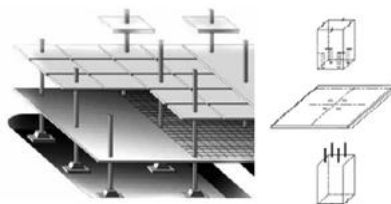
Схема каркаса и схема соединения плит перекрытий с колоннами в системе УИКСС
